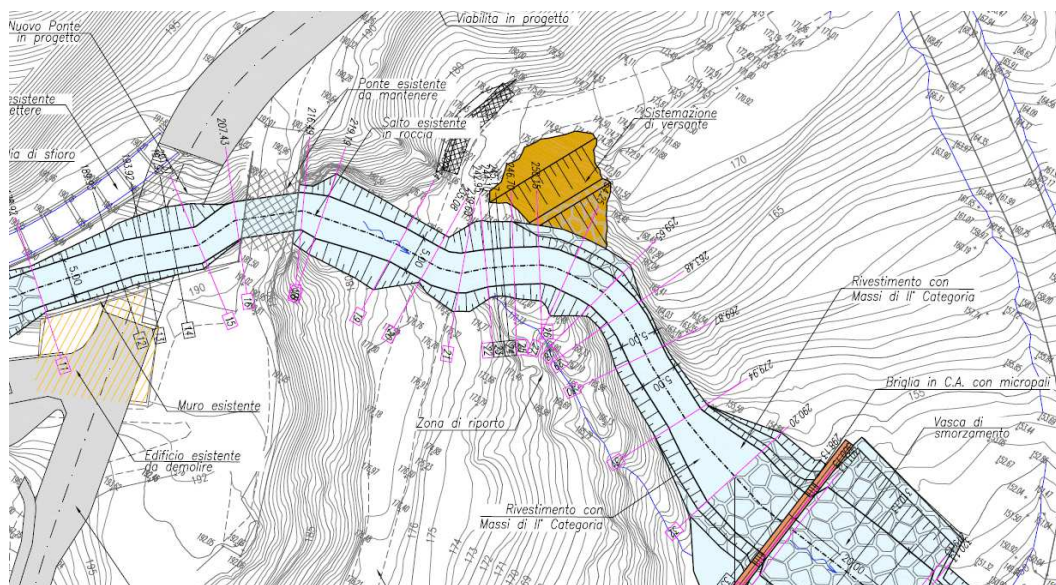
Planimetria Tavola 2/3 – Borro Pianale
